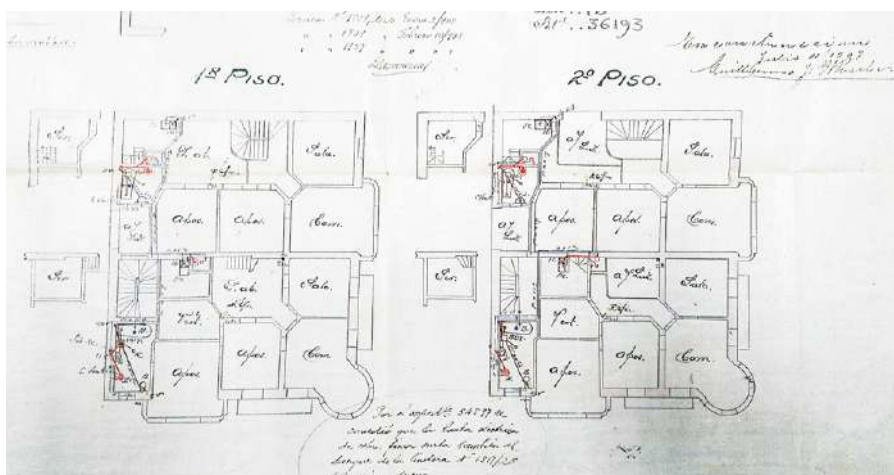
Planta original del actual edificio del "Hotel San Juan".
